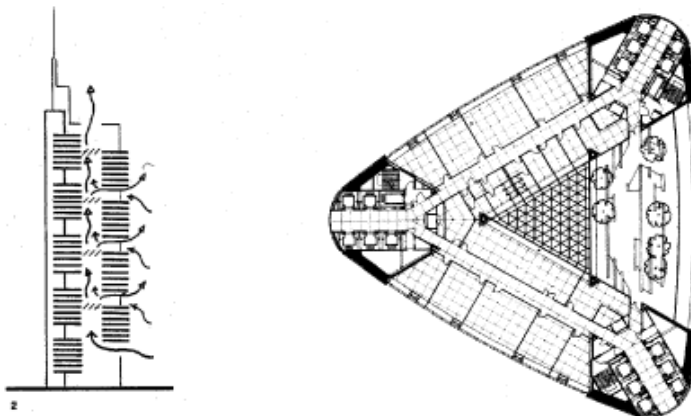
Pianta e Sezione Schematica dei Flussi di Ventilazione
